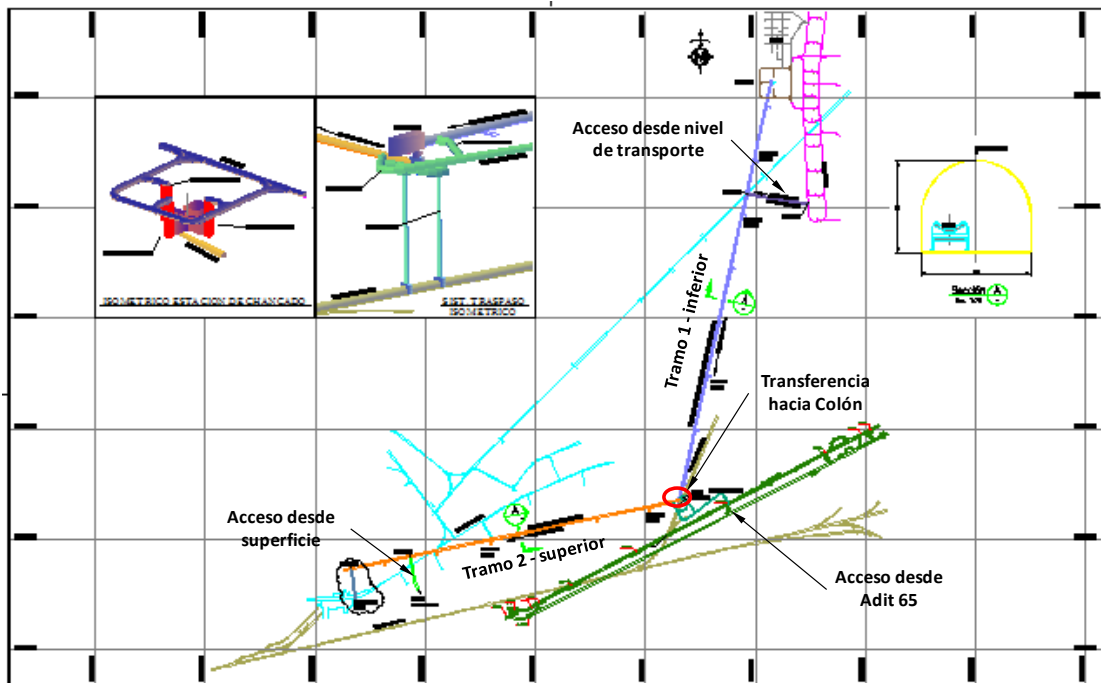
Sistema transporte principal sector Recursos Norte
